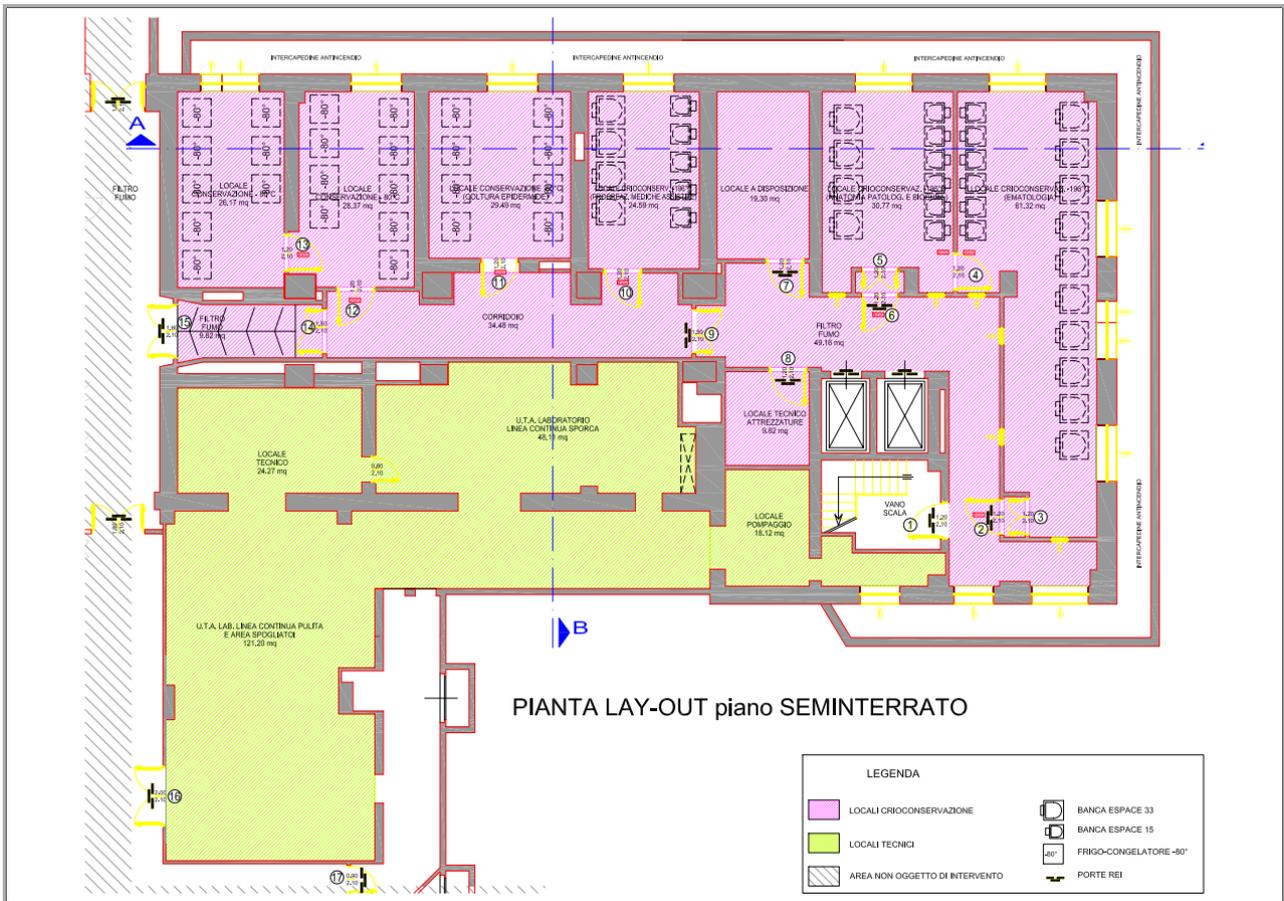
PIANO INTERRATO PAD ROSSINI
